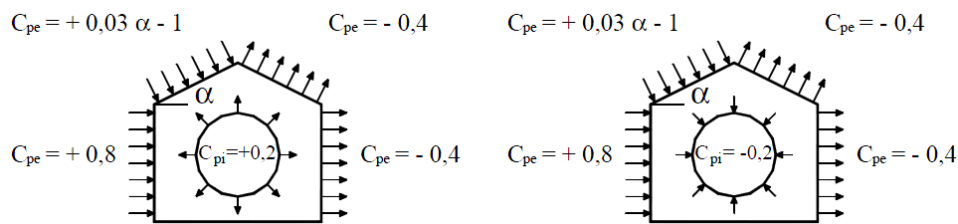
Estratto da figura C3.3.3 Circolare n.617, 2.2.2009
